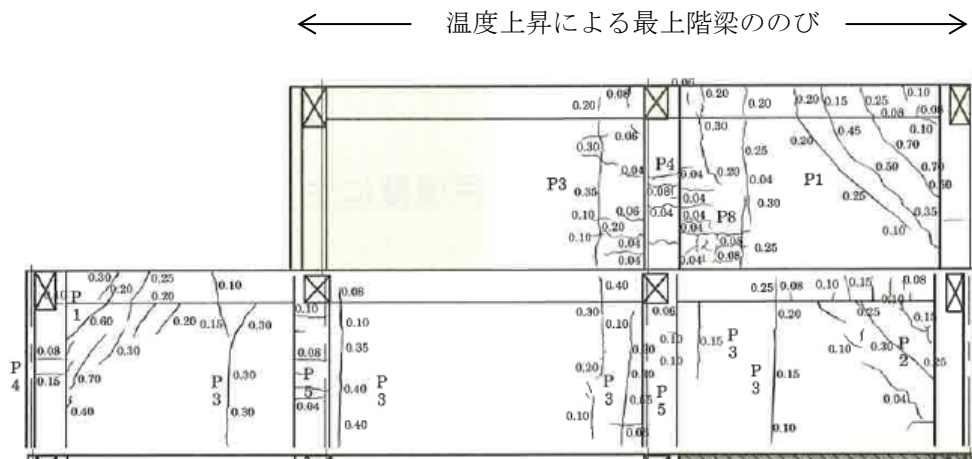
6 階建鉄筋コンクリート造建物の壁面のひび割れ発生状況
